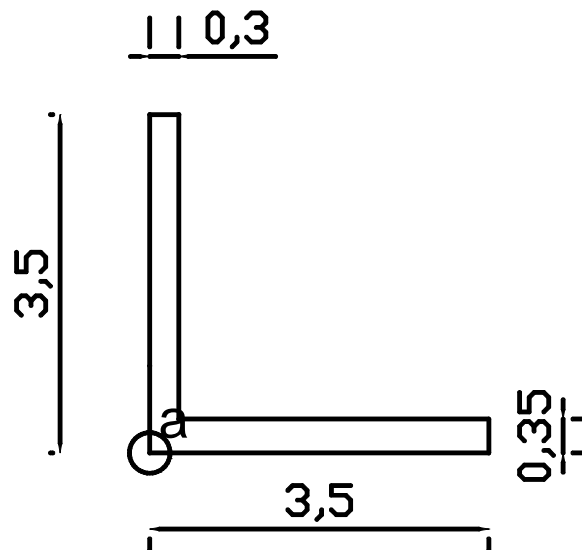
Dimensionamiento del muro de concreto armado (cotas en metros).
